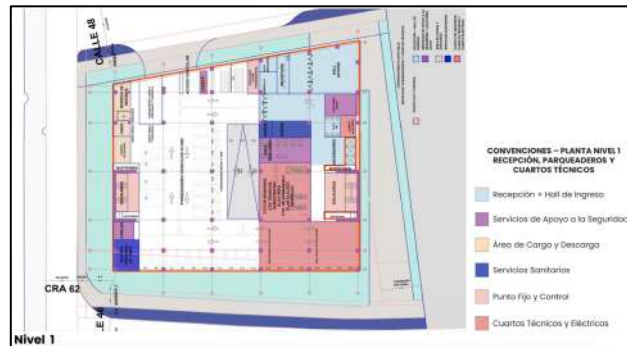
Render y del planteamiento arquitectónico proyecto
